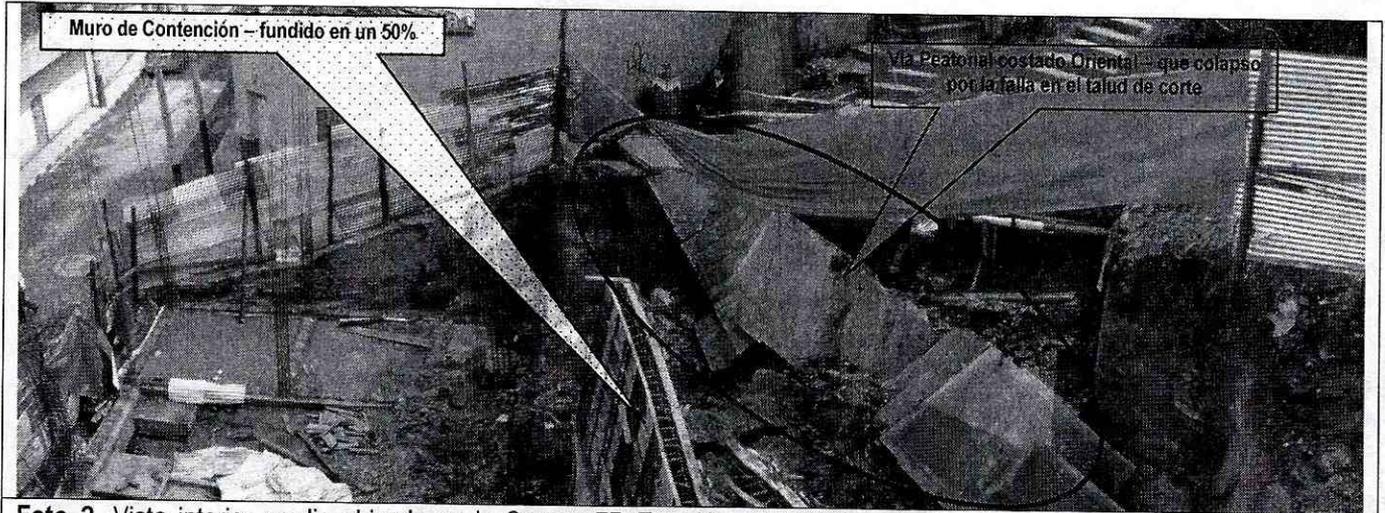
Vista interior predio ubicado en la Carrera 7D Este No. 15A-52 Sur, donde se adelantan obras tendientes a la construcción del proyecto Sede Social y de Convivencia del Barrio Sagrada Familia.
